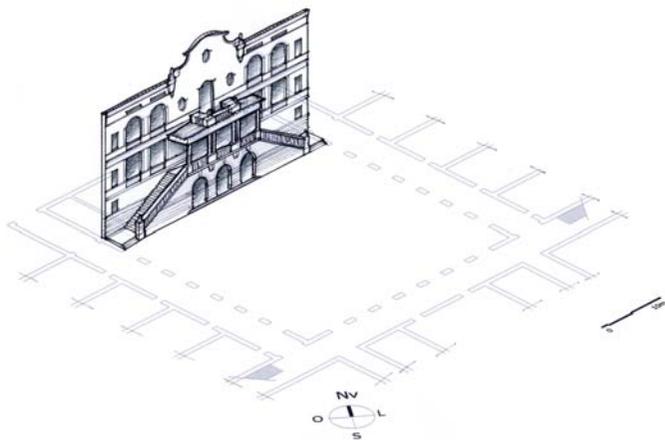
Estudo dos planos verticais, fachada Noroeste do pátio interno do ISE RJ.
